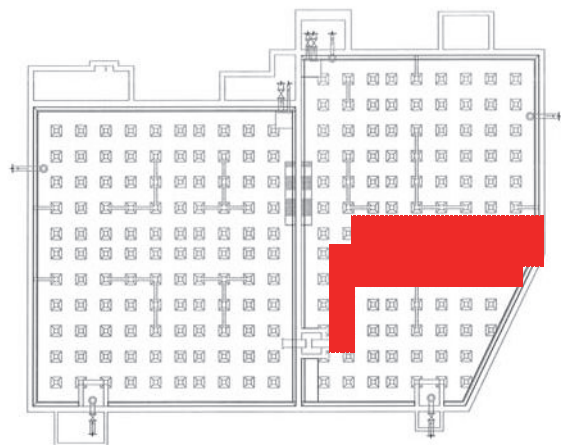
塗膜除去した配水池の平面図 (赤色部分は天井用WJ装置による施工箇所)
